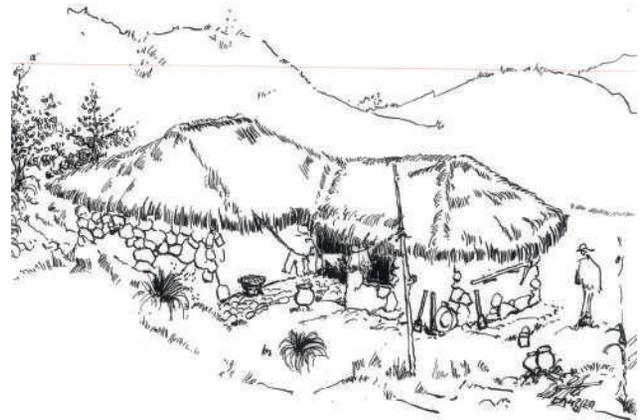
Edificación con sistema constructivo de muros de piedra.
